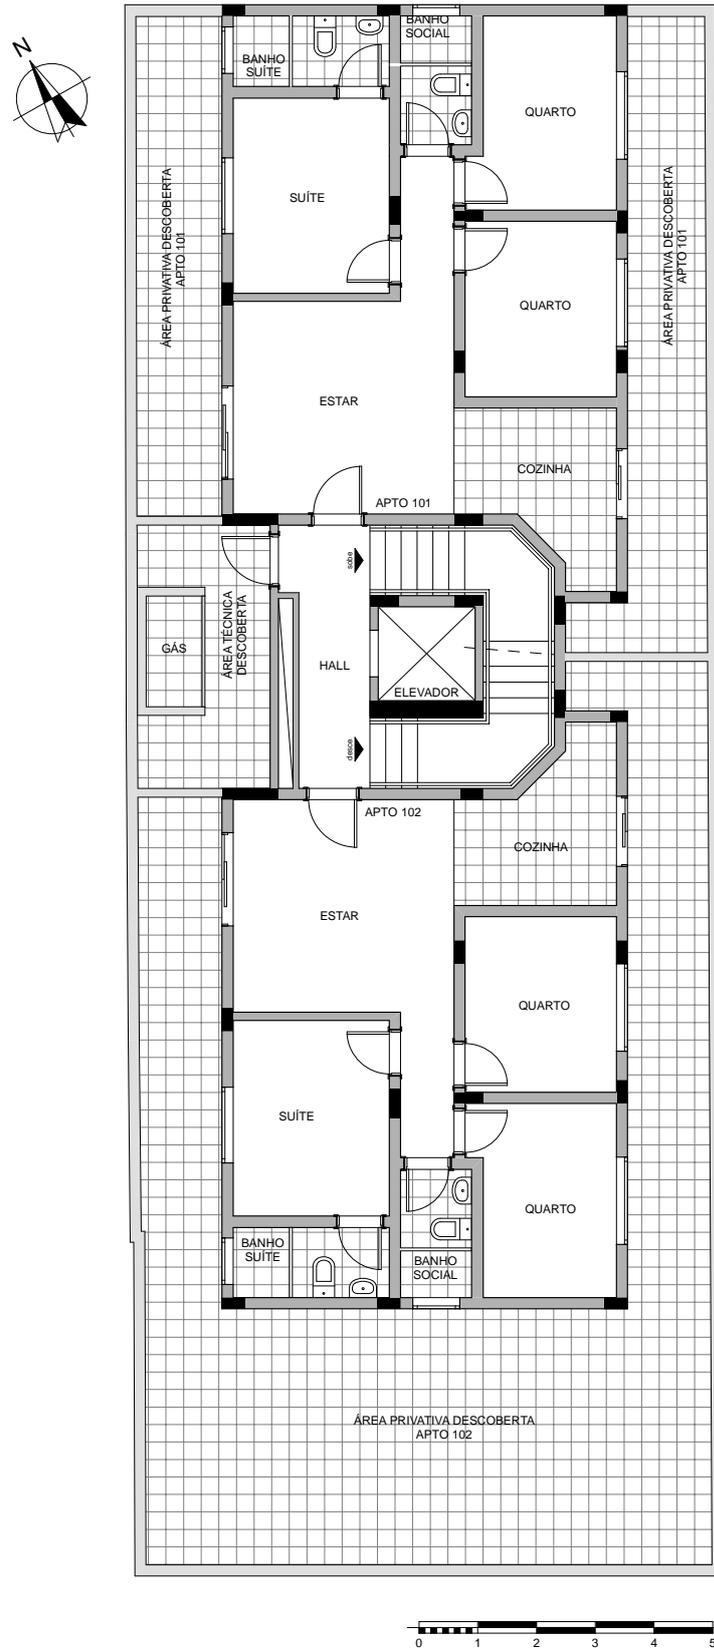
Planta 1º pavimento (Fonte: Autora, 2016)
